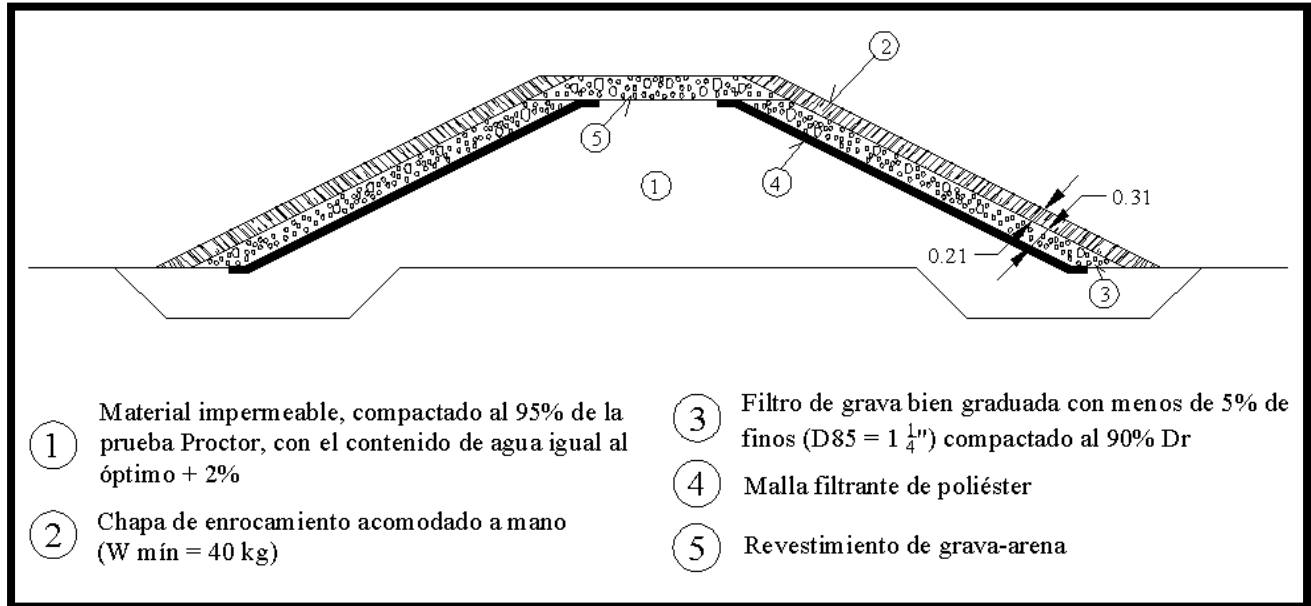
Sección de borde propuesta para lagunas de sedimentación.
